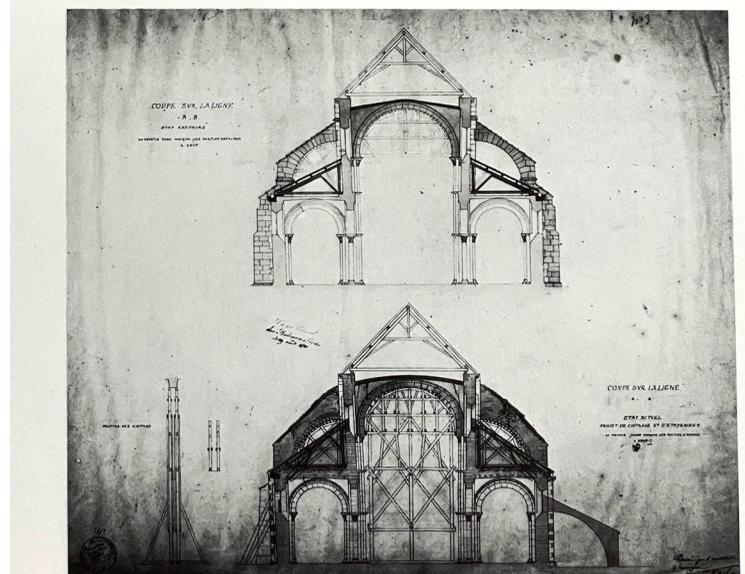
Corte transversal en la nave. Proyecto de cimentación (bajo) y estado restaurado.
